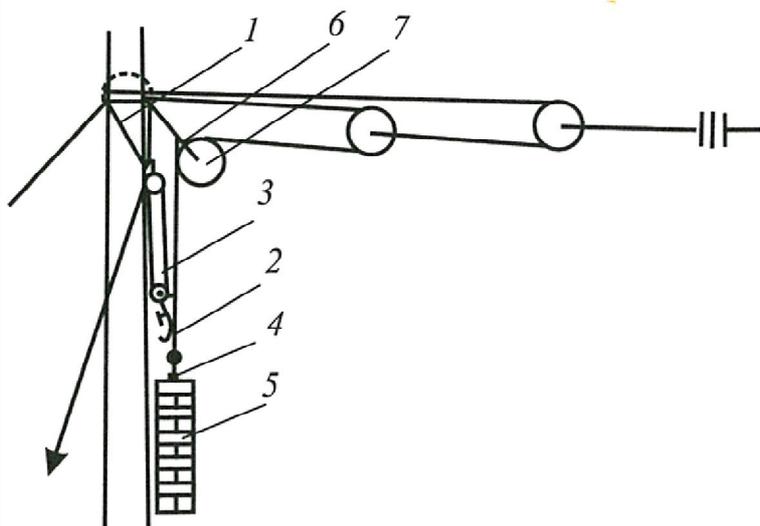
Схема закрепления компенсирующего устройства: 1 — трубка монтажная; 2 — натяжной зажим; 3 — полиспаст; 4 — грузовая штанга; 5 — грузы; 6 — болтовой зажим на тросе компенсатора; 7 — неподвижный блок компенсатора
